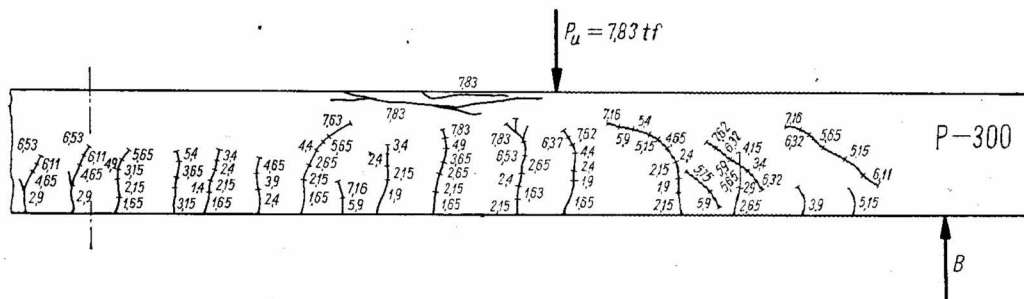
Fissuration de la poutre P-300 sous la charge  $P_u = 7,83$  tf
